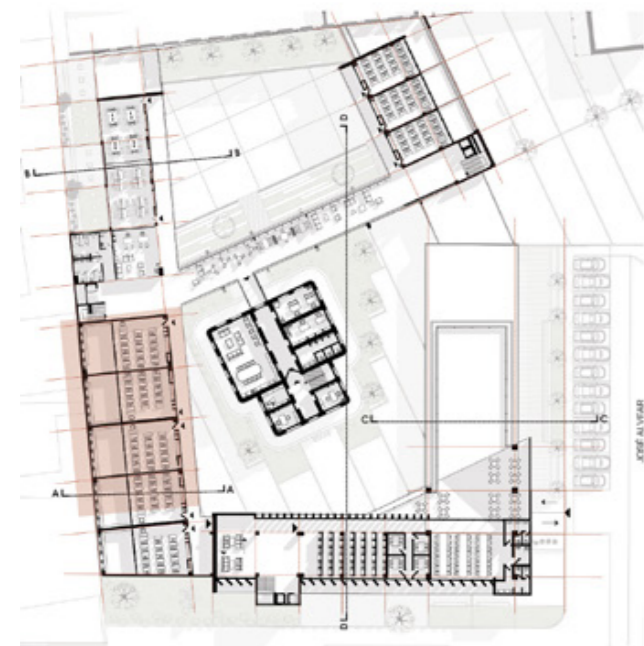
Esquema Planta alta | Fuente: Elaboración propia
